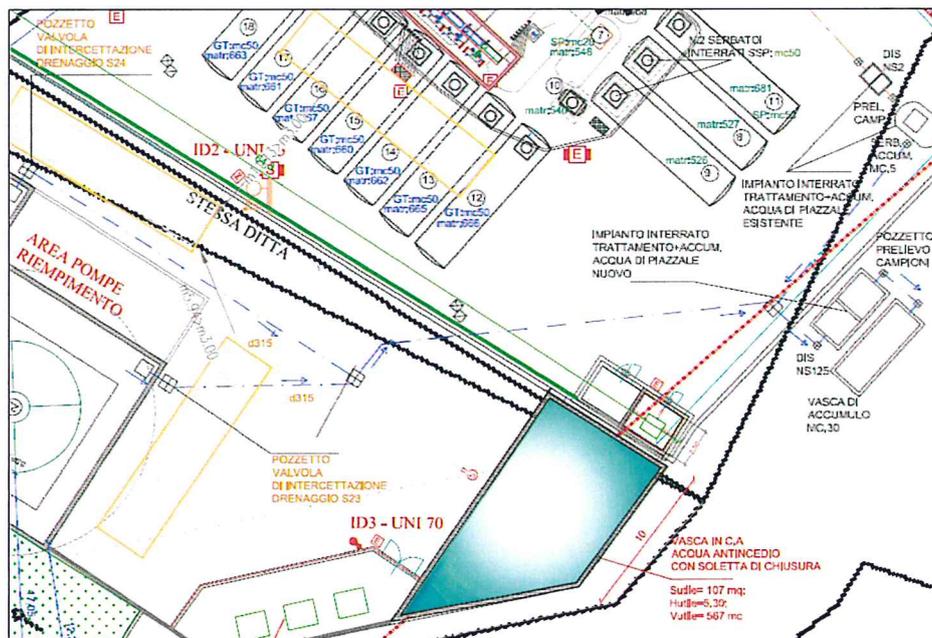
Impianto di drenaggio e trattamento acque di piazzale (da Elab. T7 allegato allo SPA)
